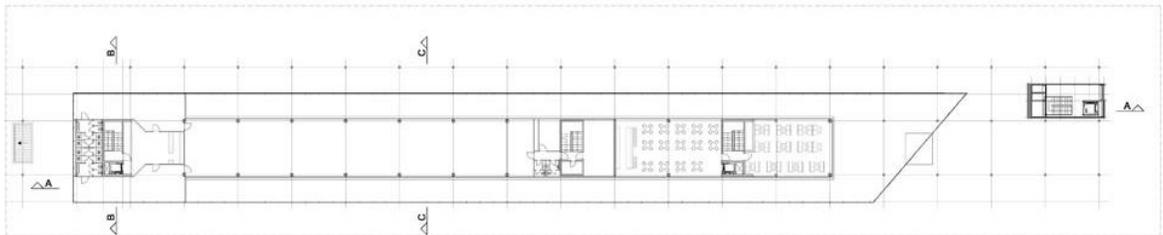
Planta arquitectónica terminal de buses de Osijek.
